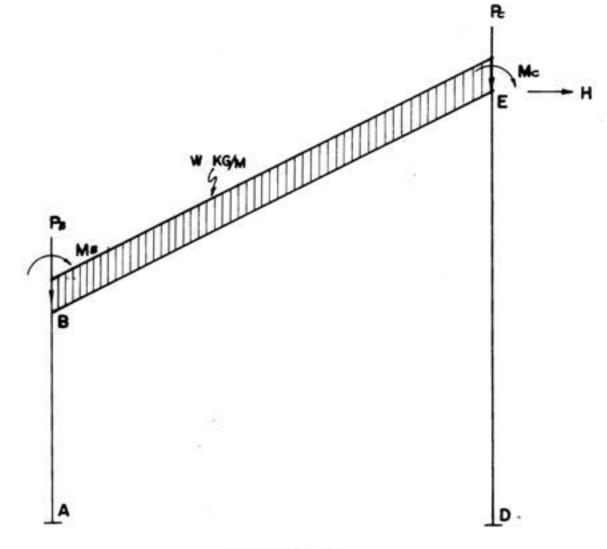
DIAGRAMA DE CARGAS EN LA VIGA BC DEL PORTICO ABCD
